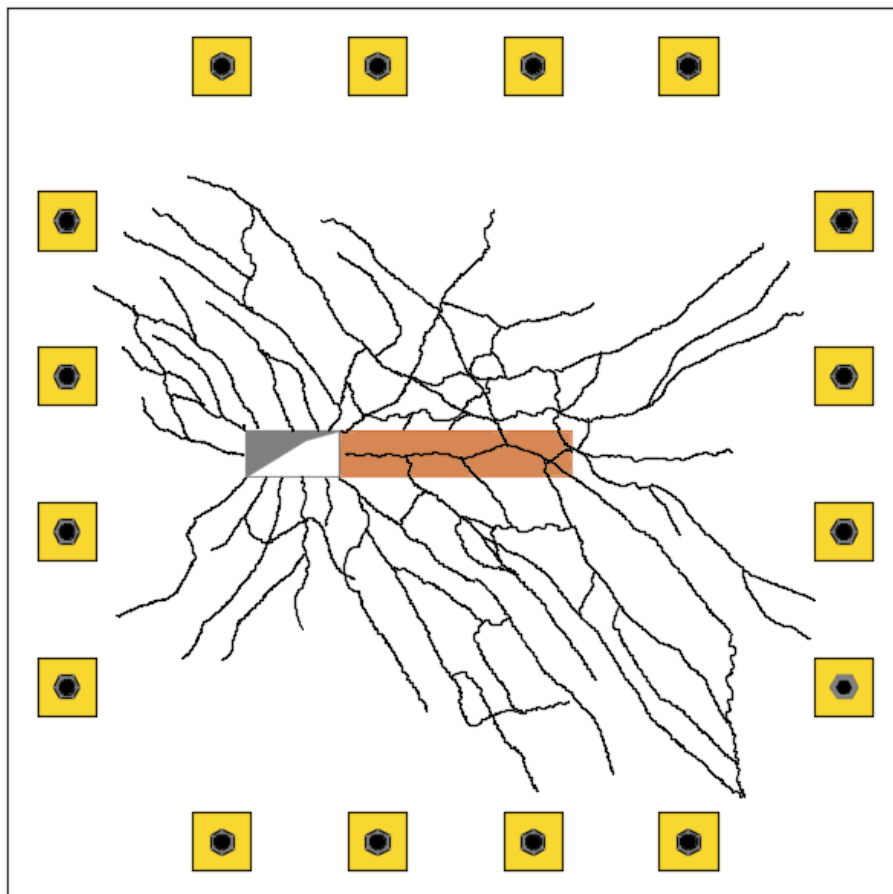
Padrão de fissuração da laje L3C2
